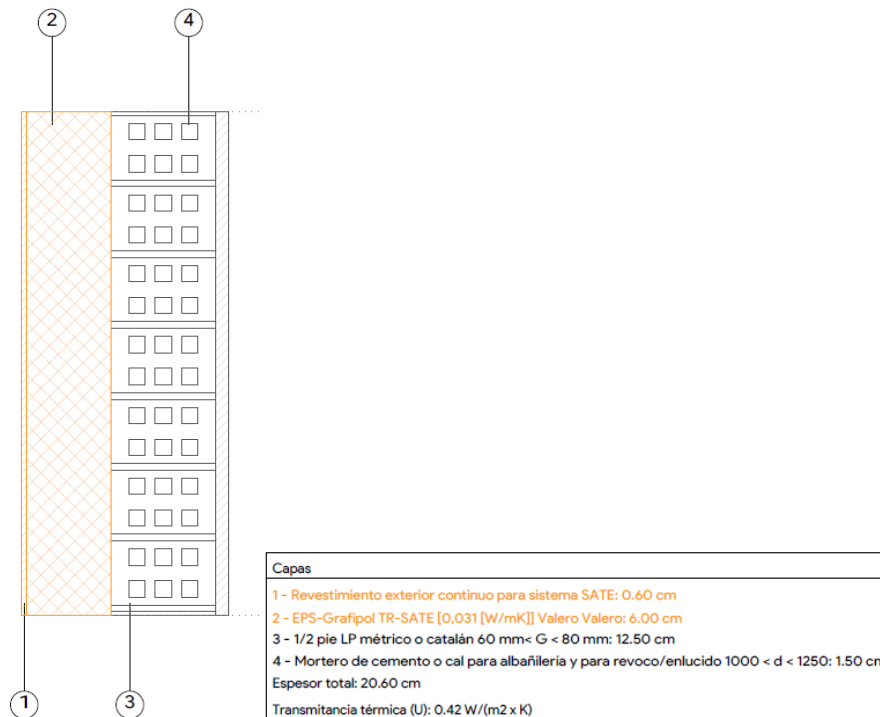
Detalle de muro estructural extremo mejorado (Elaboración propia)
